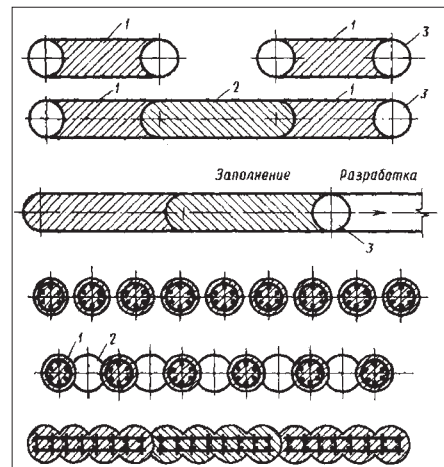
Виды траншейных и свайных стен, выполненных в грунте:
